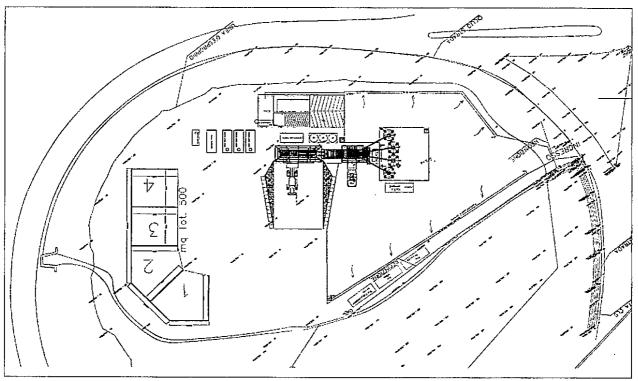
Impianto di calcestruzzi Cannemaschi – layout di cantiere
